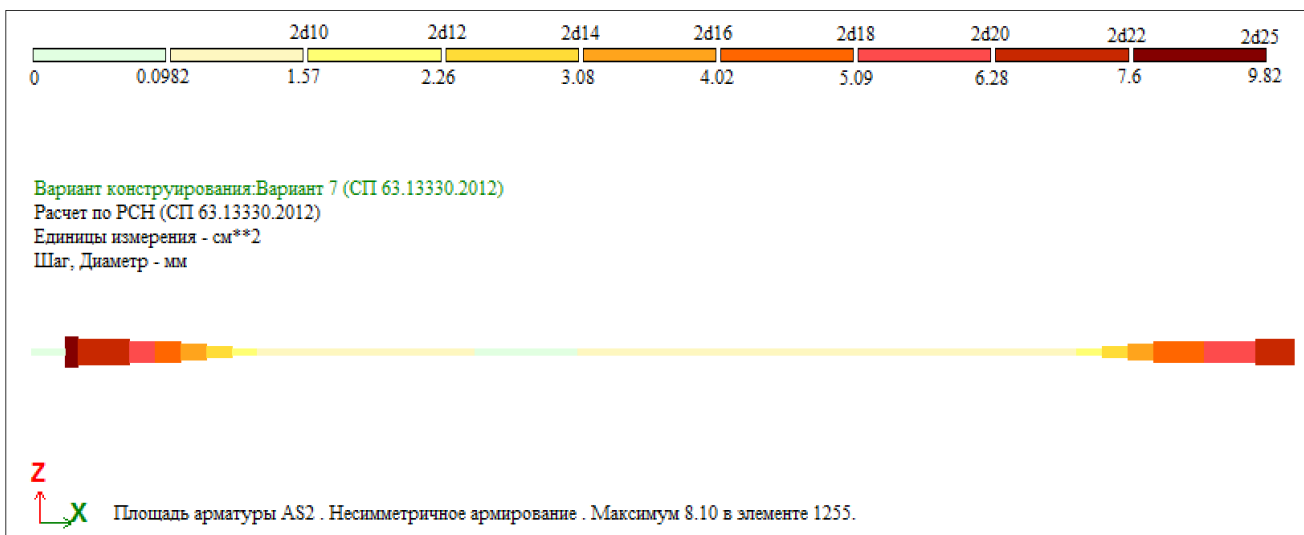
Распределение верхней продольной арматуры контурной балки
